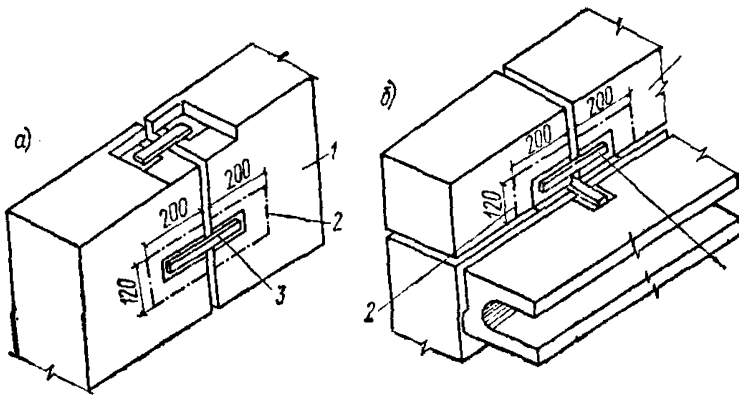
Узлы соединений рядовых фасадных стен домов серии 1-468
